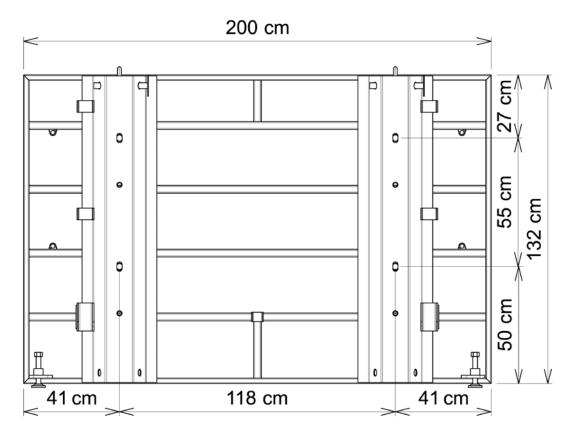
Sous-hausse GTI 132 x 200 (Réf. 604200)
